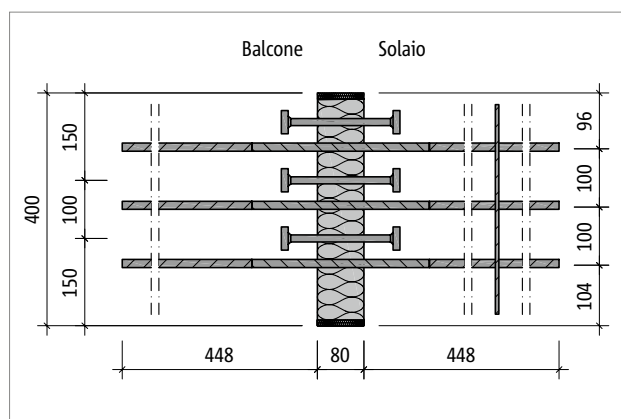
Schöck Isokorb® T tipo QP-V9: pianta del prodotto
